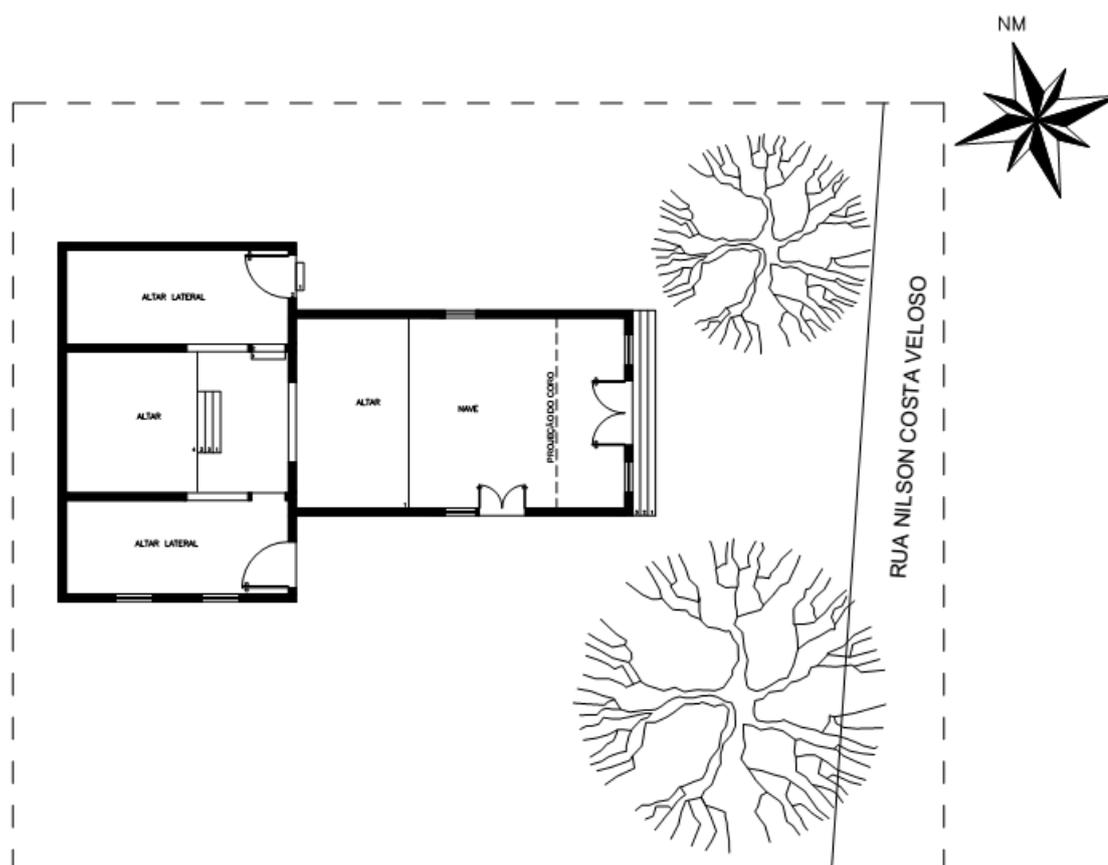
Planta do térreo da Capela de Nossa Senhora da Conceição (Nunes, 2014).
